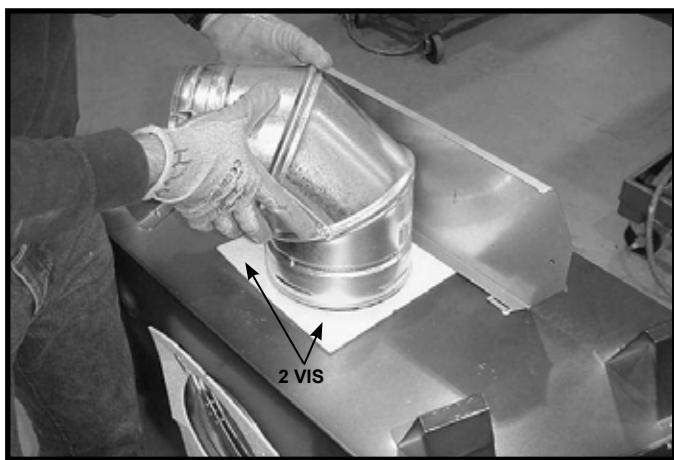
Pour fixer la première section du conduit d'évacuation, assurez-vous d'utiliser le joint d'étanchéité en fibre de verre pour sceller entre le premier composant et l'enveloppe extérieure du foyer. Utilisez 2 vis autotaraudeuses pour fixer le joint d'étanchéité à l'enveloppe extérieure.
